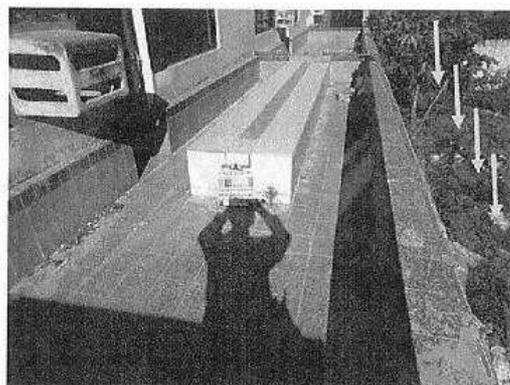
Identificação da construção sobre o muro de divisa do terreno. Indicação do terreno ao lado.
